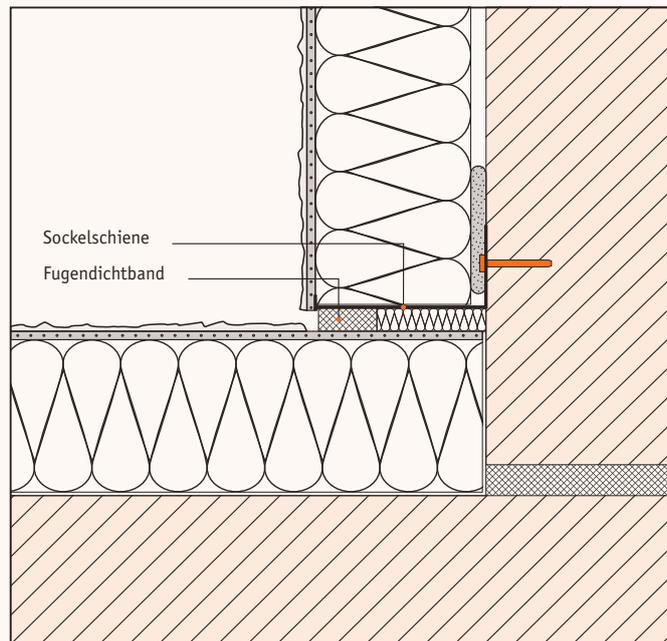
Vertikale Bewegungsfugen mit Dichtband (Horizontalschnitt)
